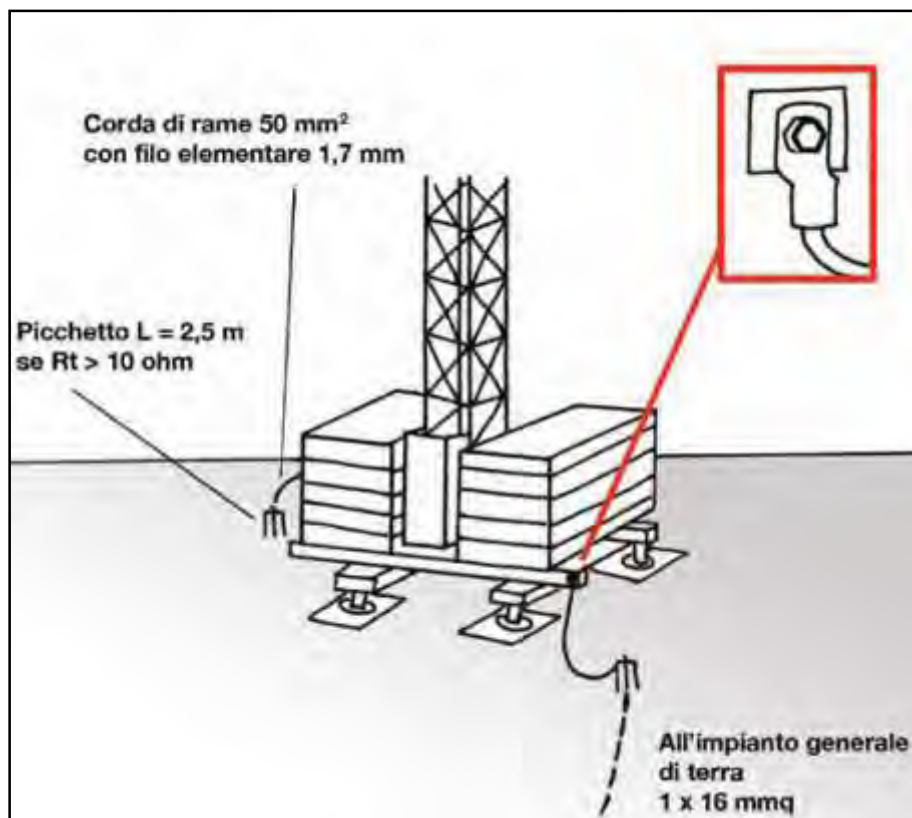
protezione contro i fulmini per una gru in postazione fissa [4]
